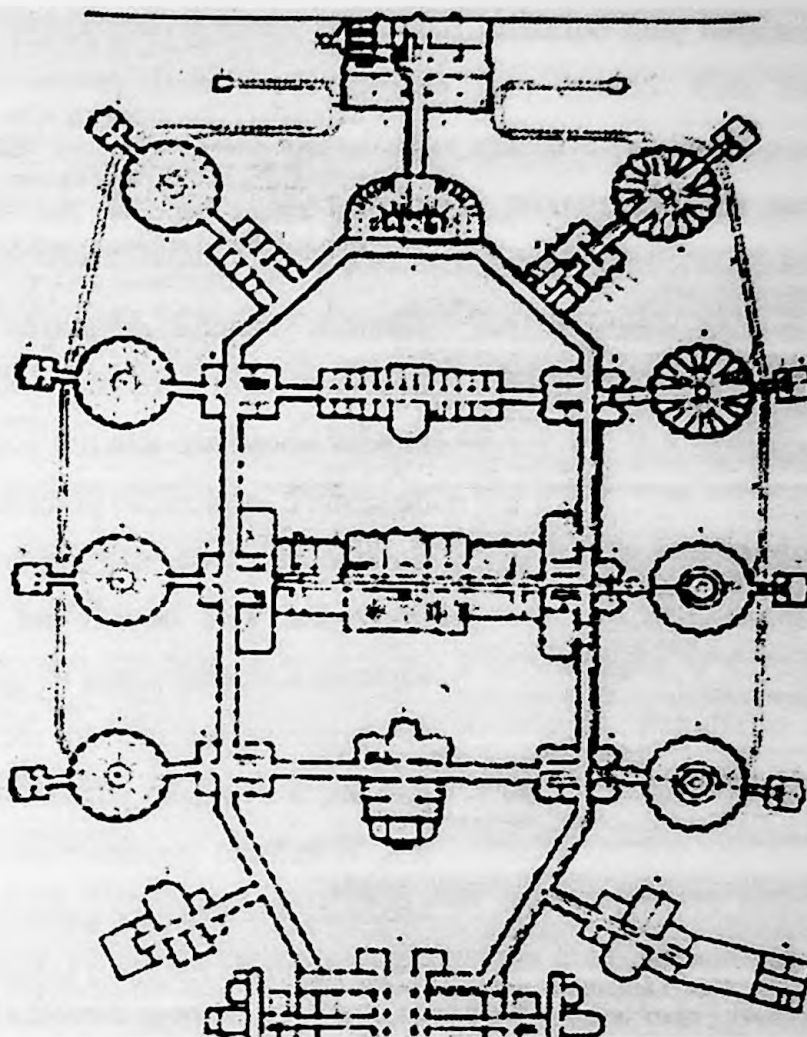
Planta de Hospital civil, Antuérpia (1878).
